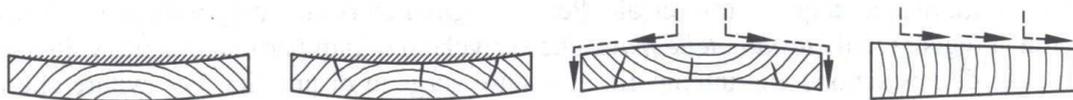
Ristagno o deflusso dell'acqua provocati dalla deformazione delle sezioni di una tavola, con problemi aggravati dalla posizione delle fessure.
